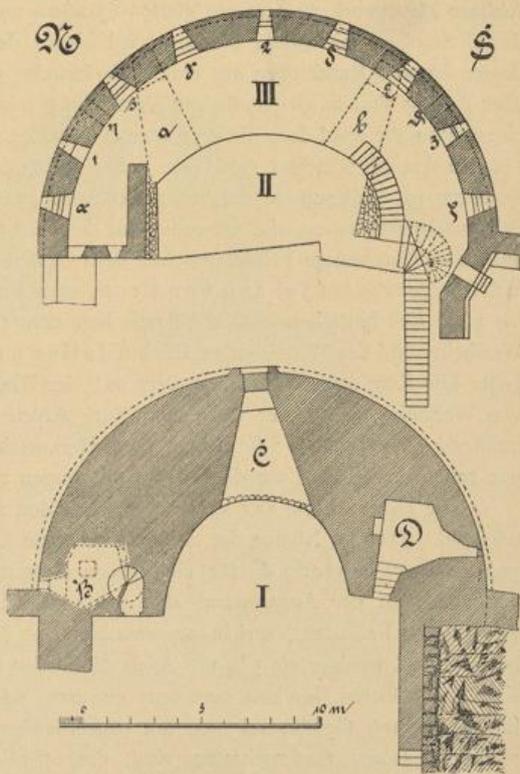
Burg Wertheim. Vorderes Bollwerk. Grundrisse.
